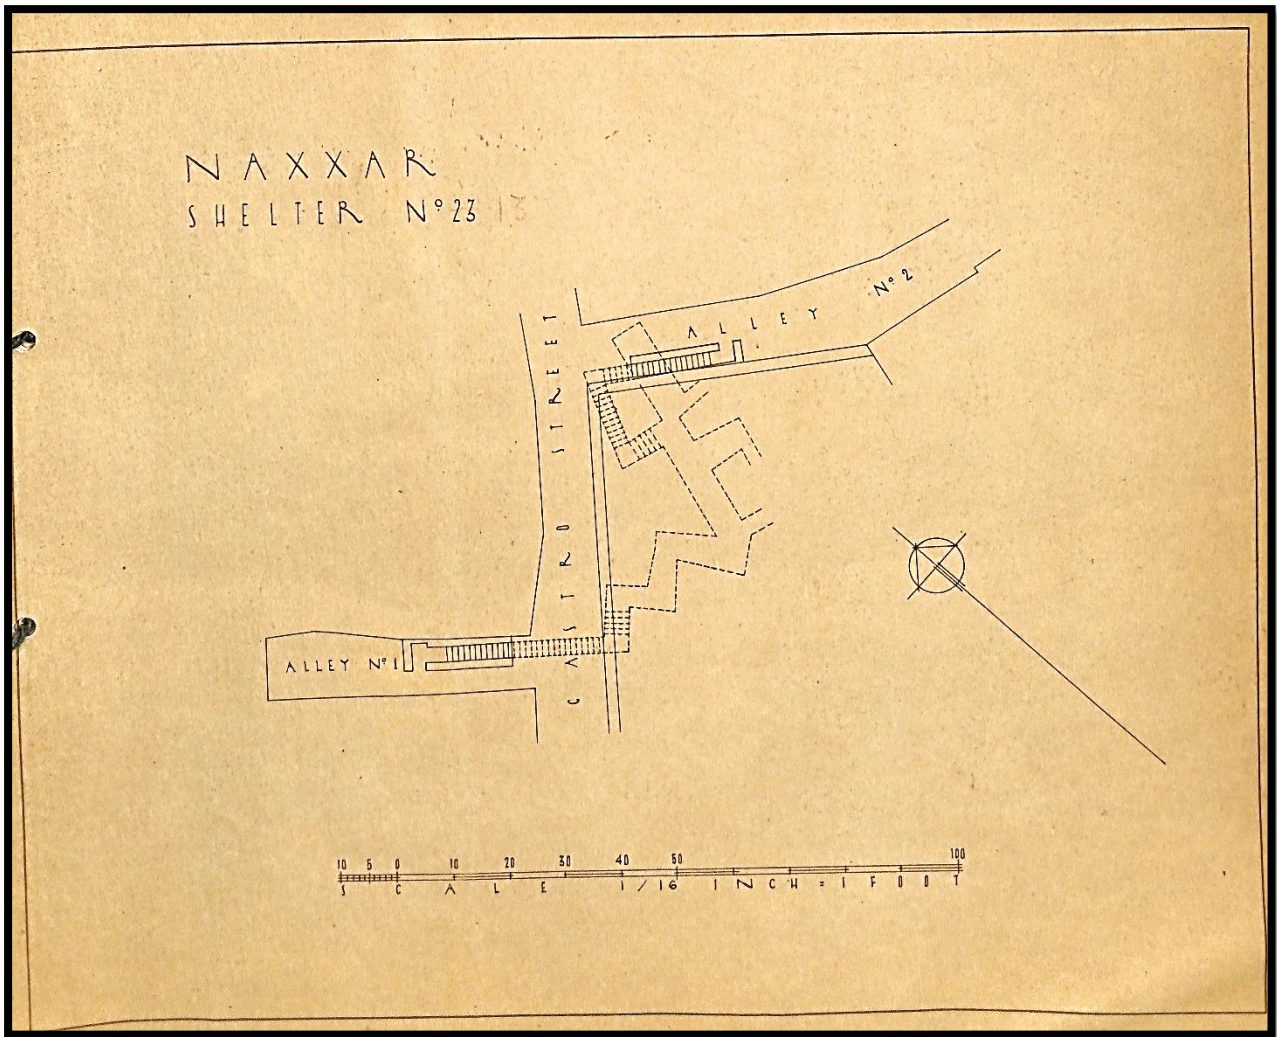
Planta do Abrigo nº23 (13) "Castro Street – Alley nº1 – Alley nº2"
